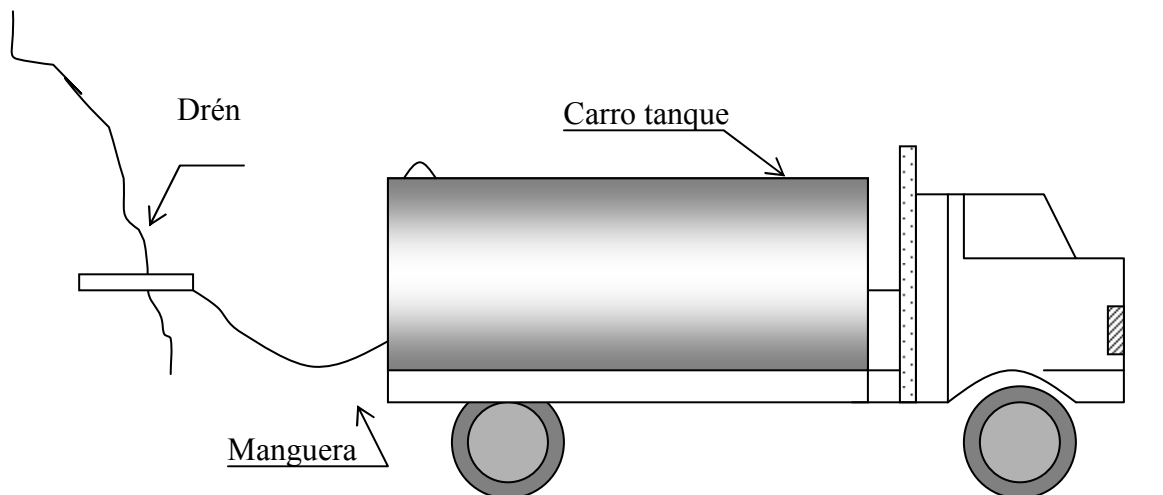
Lavado drenes horizontales. (Elaborado por los autores).
